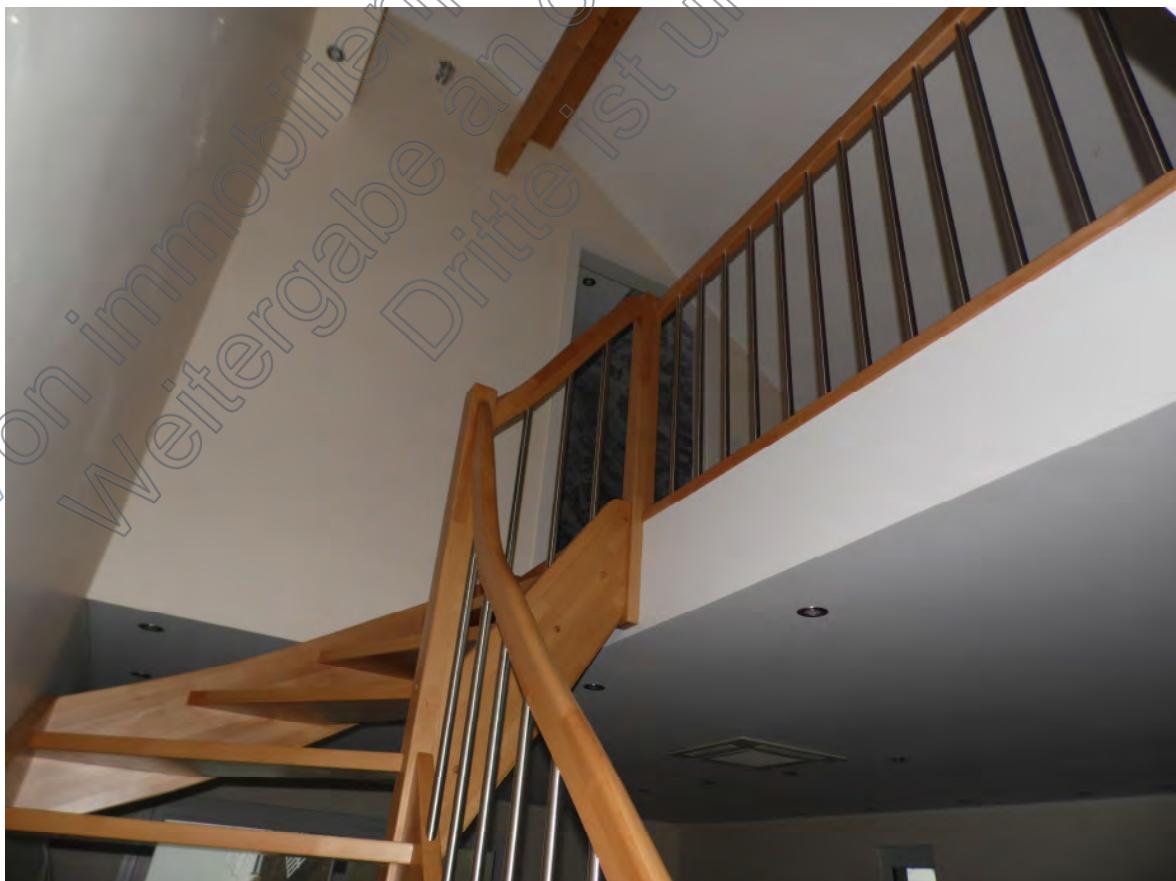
Ausschnitt – Treppe zum „ausgebauten“ Spitzbodenaeschos
